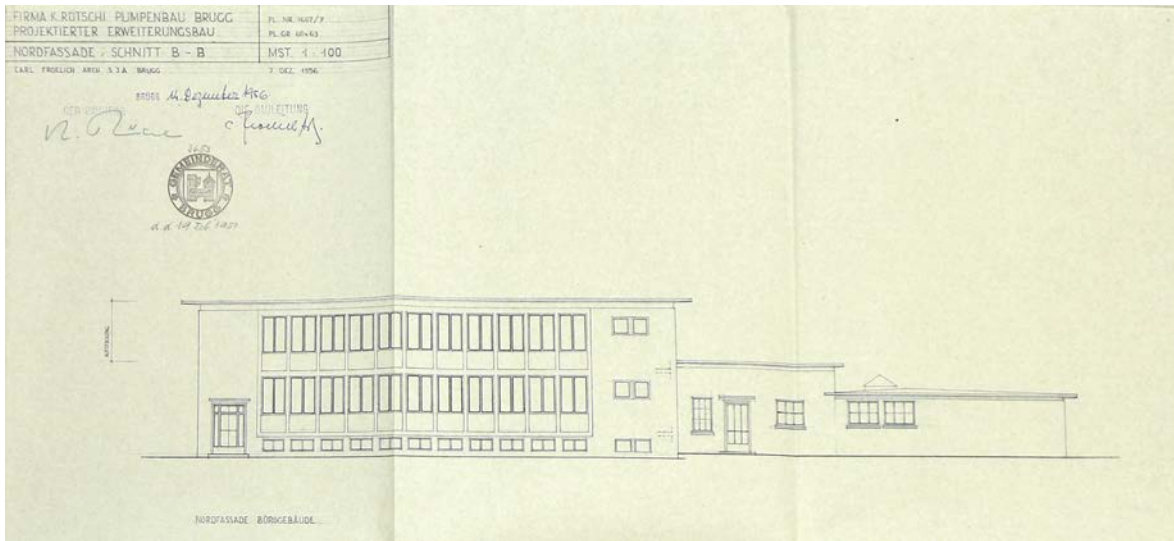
Baueingabeplan Aufstockung Bürogebäude 1957 Ansicht Nordfassade. (Baugesuchsarchiv Dossier 2653)
